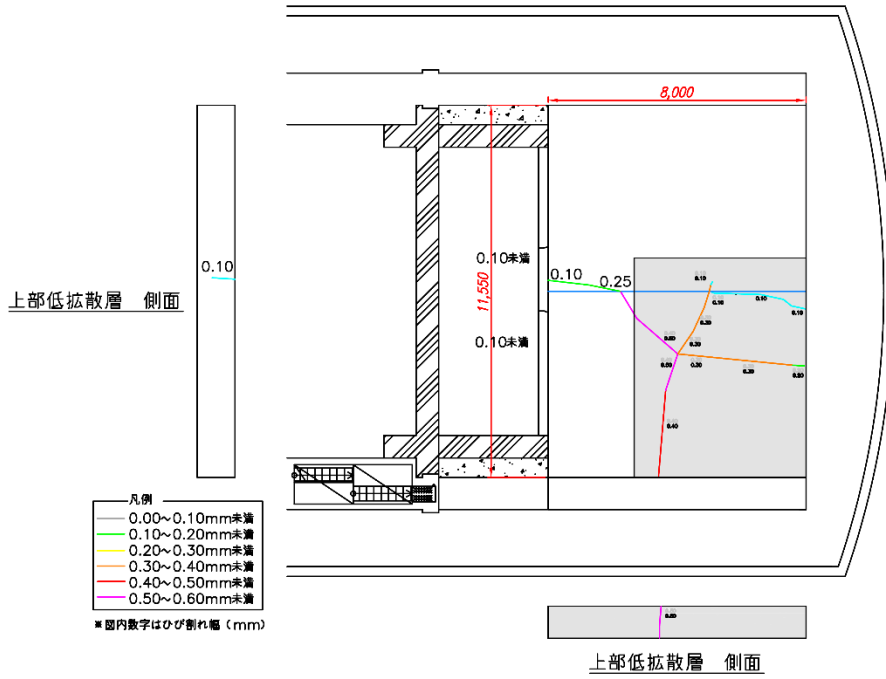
上部コンクリートピットおよび上部低拡散層のひび割れ履歴図 (その 3)
